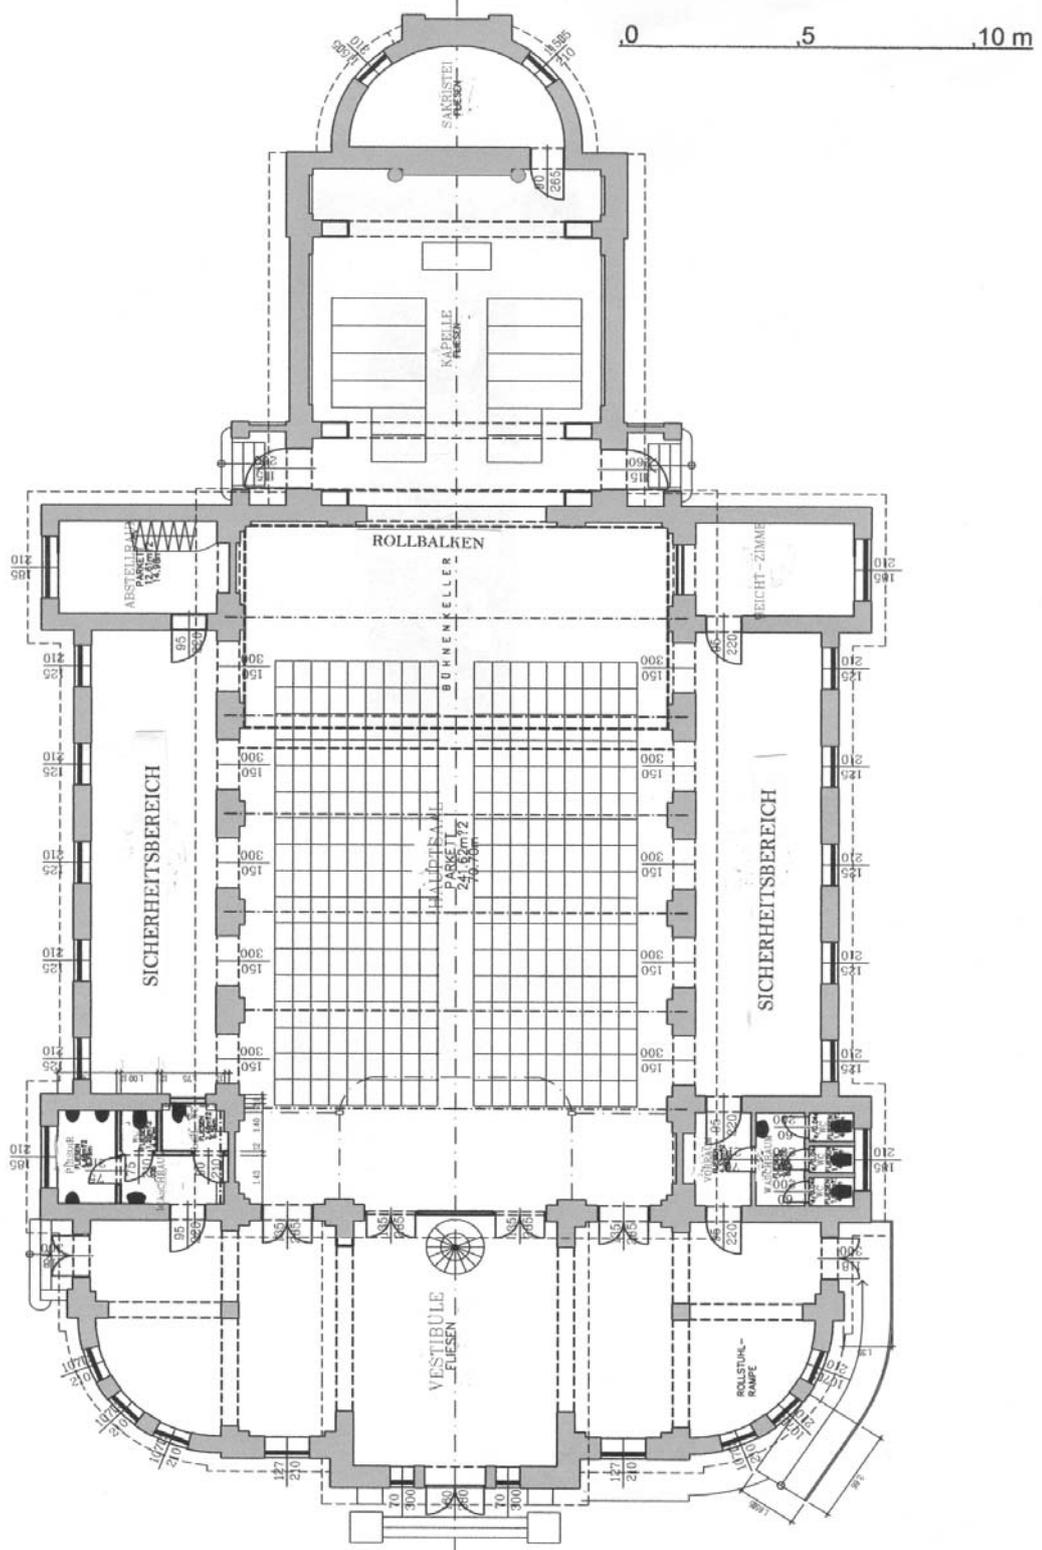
GRUNDRISS DES GESELLSCHAFTSHAUSES
